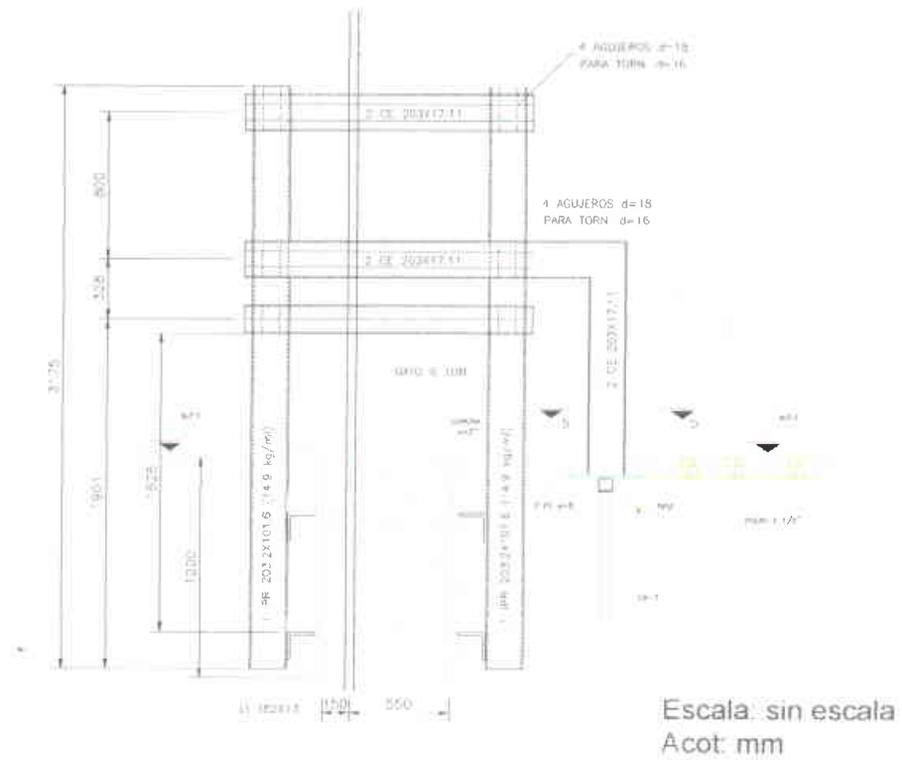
Armado cabrillas y colocación de piernas, silos de cemento 3 y 4.
